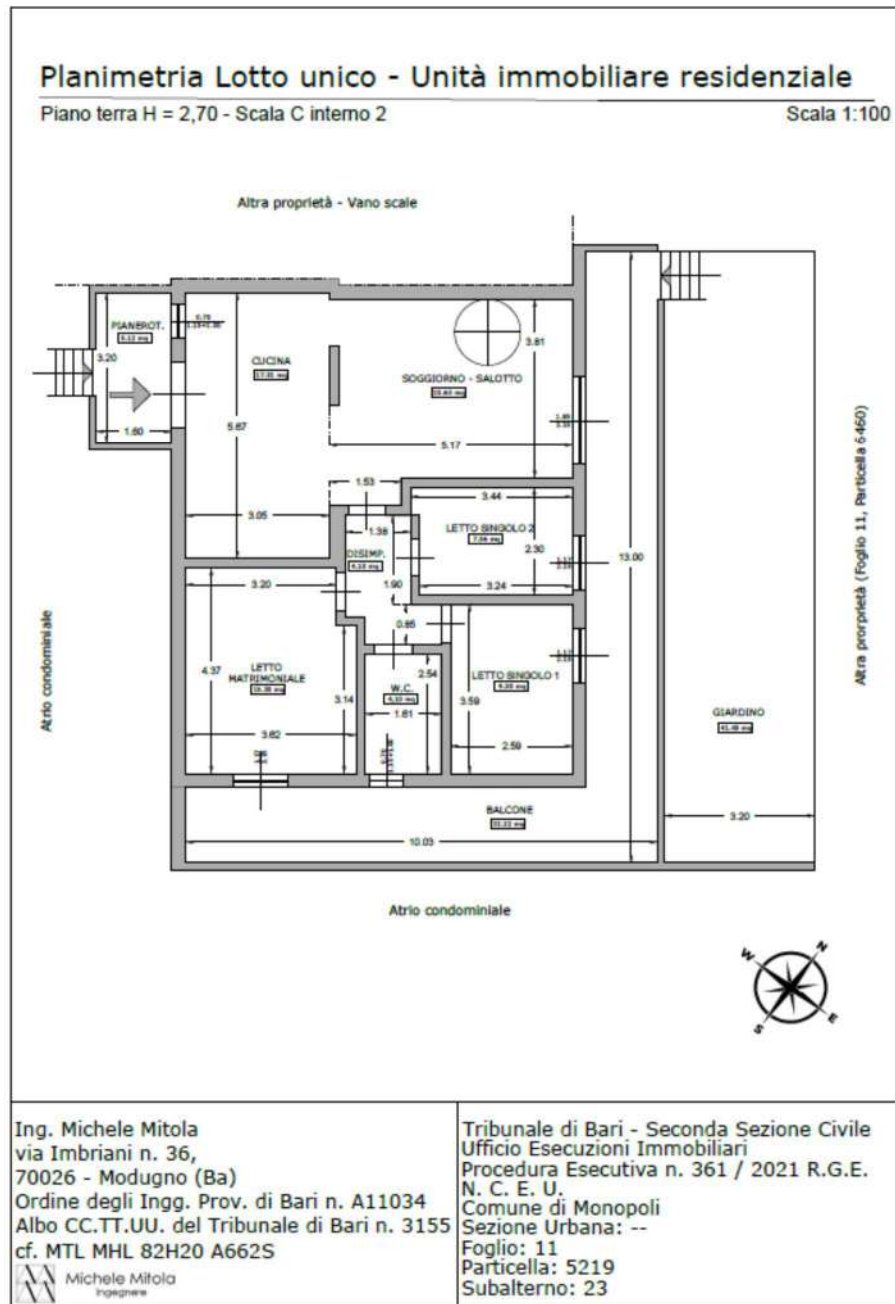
Stato dei luoghi rilevato dal C.T.U.
